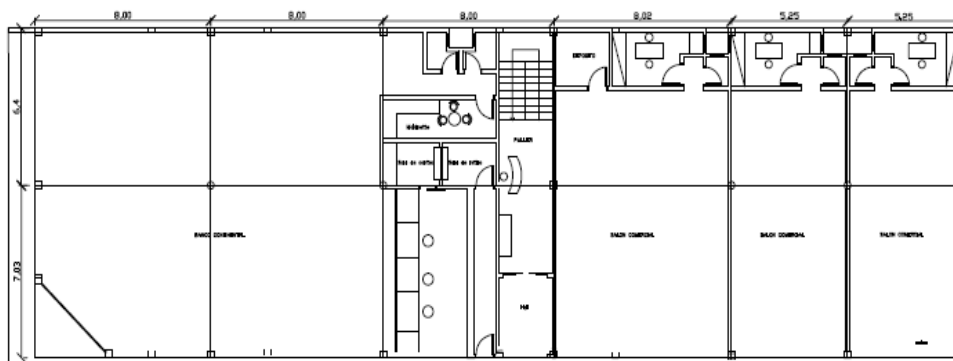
17 – planta baja del diseño utilizado para el análisis comparativo
